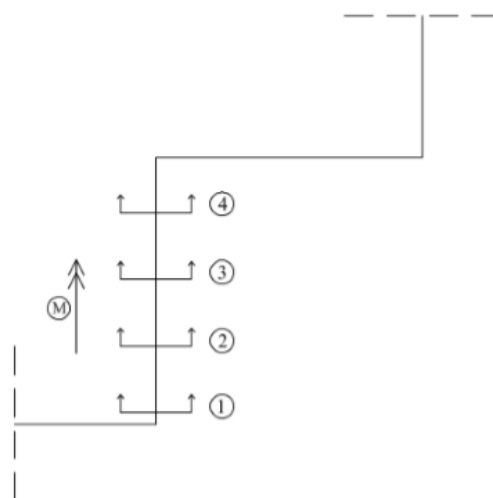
Secções verticais dos layouts de cantos (Szepesházi, et al., 2016)
